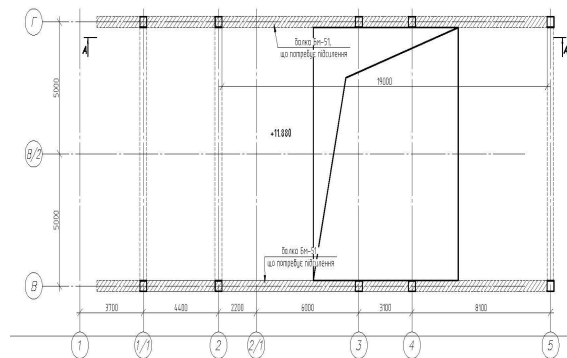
Фрагмент залізобетонного перехресно-ребристого перекриття на відм. +11.880 в осях 1-5, В-Г
